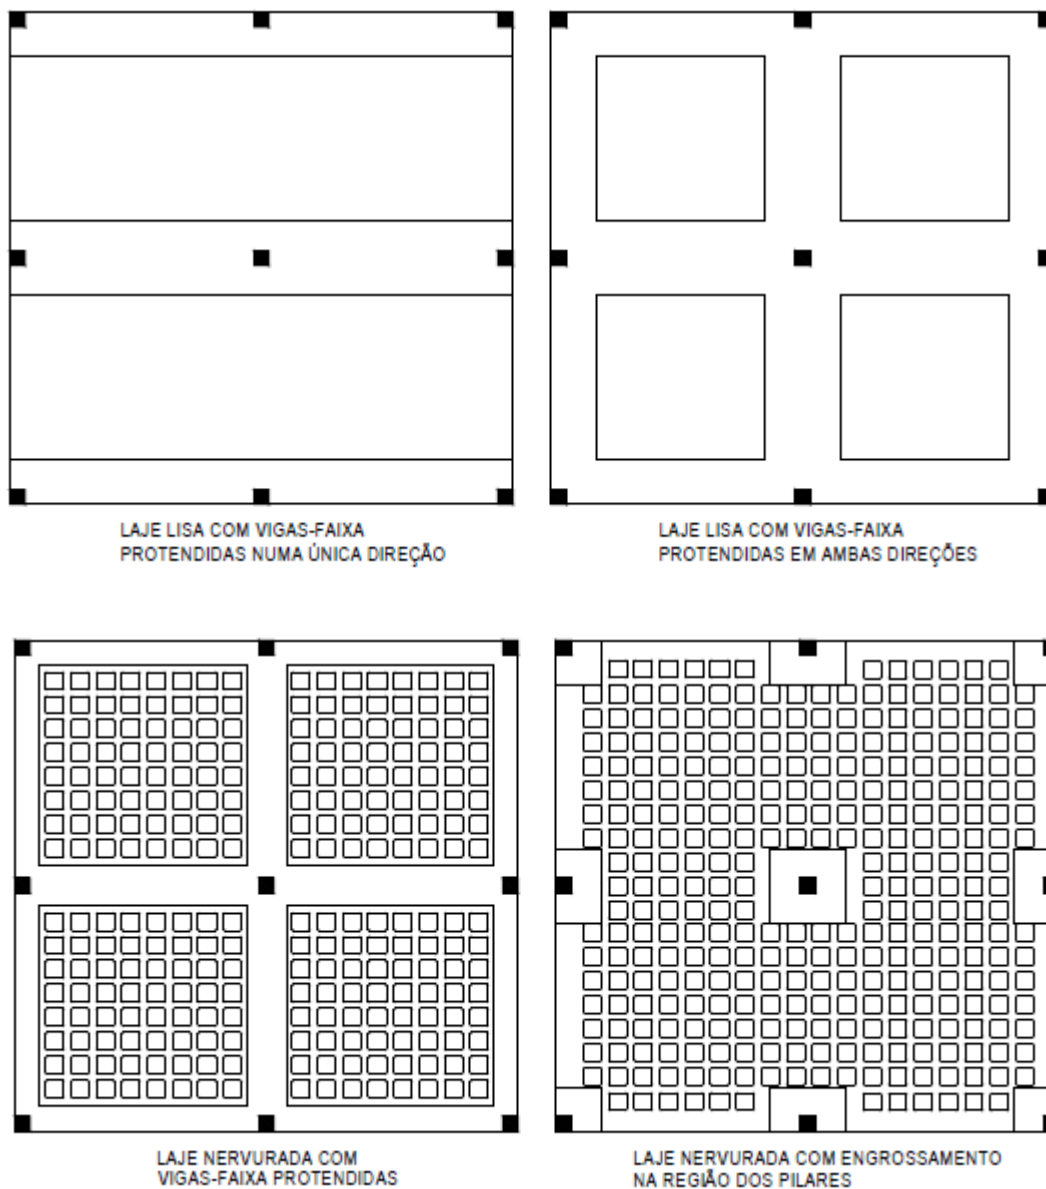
Esquemas Estruturais para Lajes Protendidas
